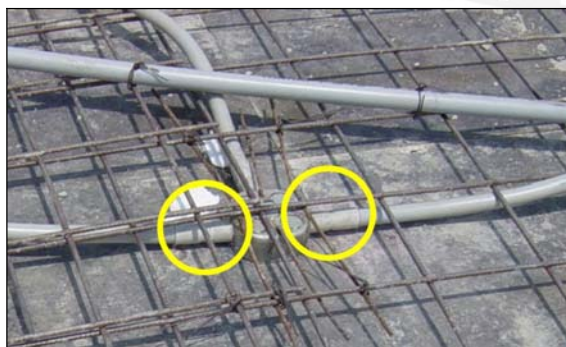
Poco Recubrimiento entre la Tubería y el Fondo de Losa
